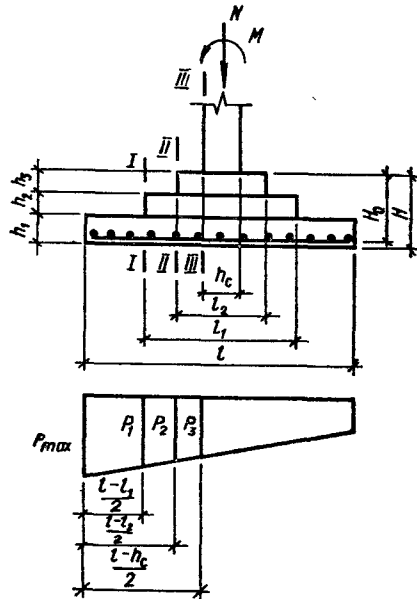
К определению площади сечения арматуры подошвы фундамента.
